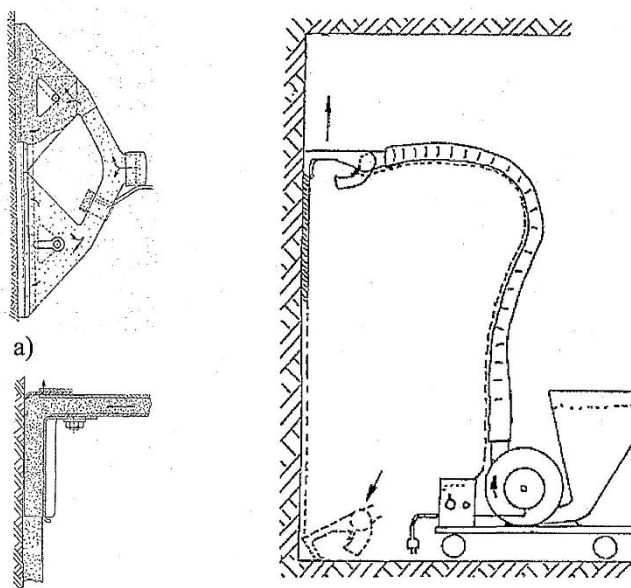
Пристрій для покриття поверхонь будівель густою масою, що схвачується: а — вид зверху; б — розріз; В - робота пристрою.
